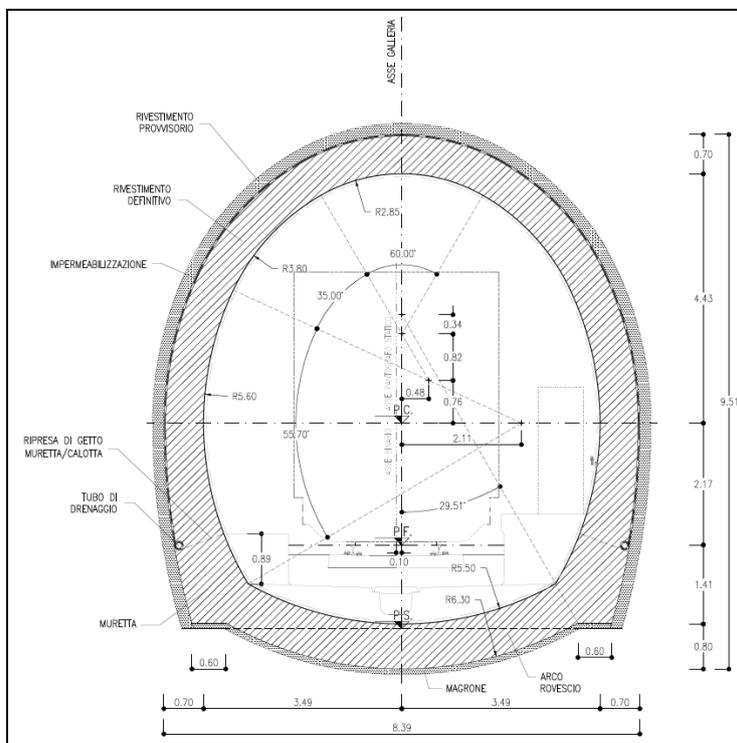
Sezione di intradosso galleria di linea a singolo binario per scavo tradizionale (sezione corrente)
